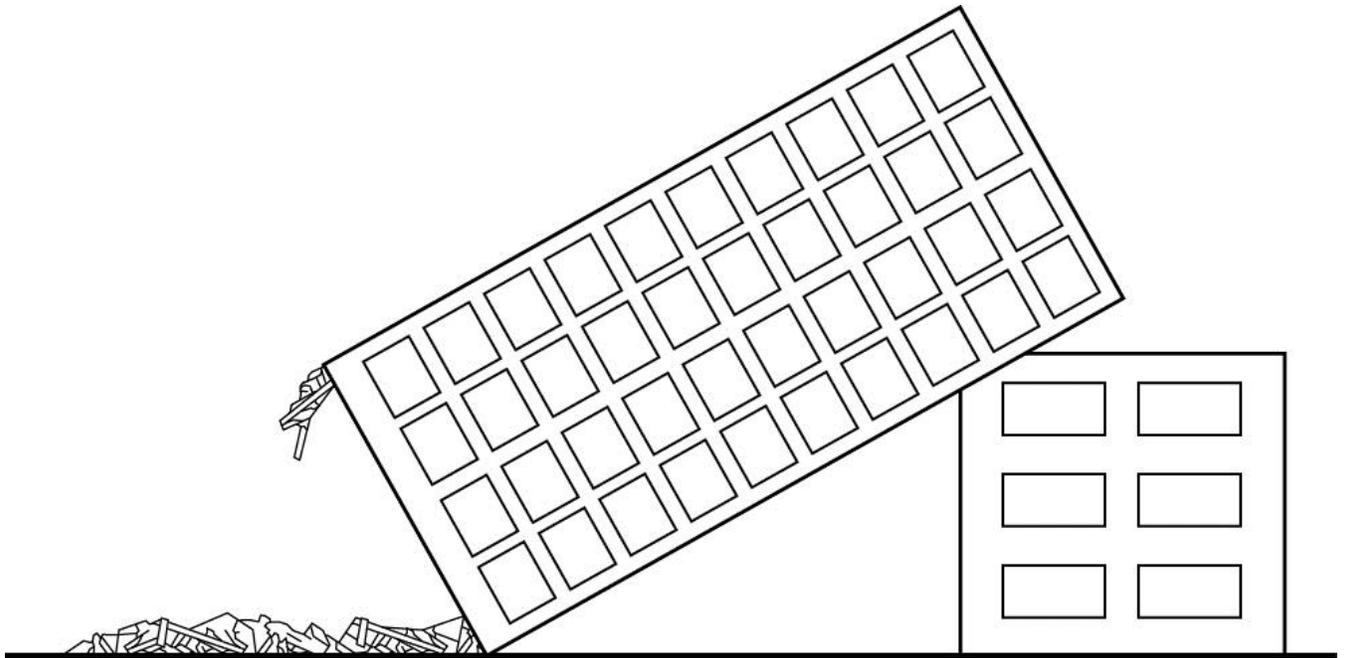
(f) Soft primer patrón de historia Collapse - Pesado Floor construcción.
